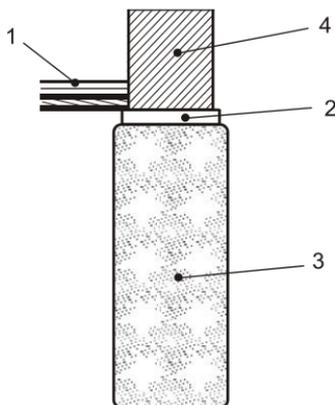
Устройство гидроизоляции фундамента здания без подвала при отсутствии грунтовых вод: 1 — уровень чистого пола 1-го этажа на отметке 0,000; 2 — горизонтальная гидроизоляция стен на отметке $-0,30$; 3 — фундамент; 4 — стена
